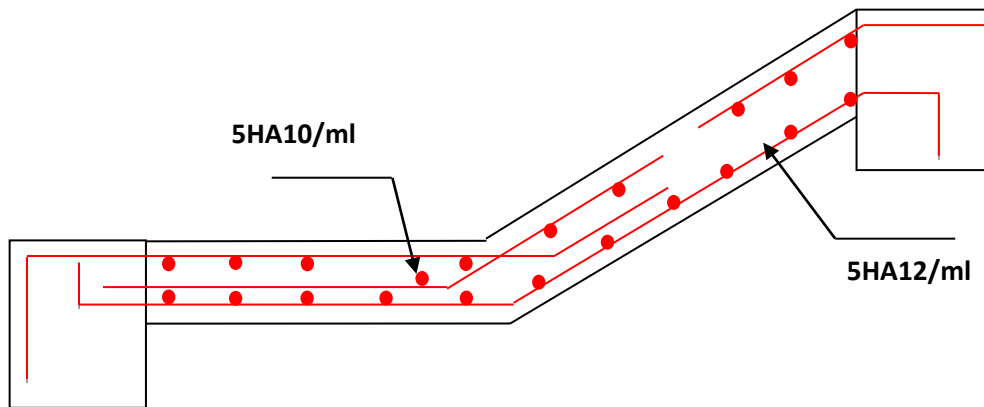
Schéma de ferrailage de l'escalier type II
